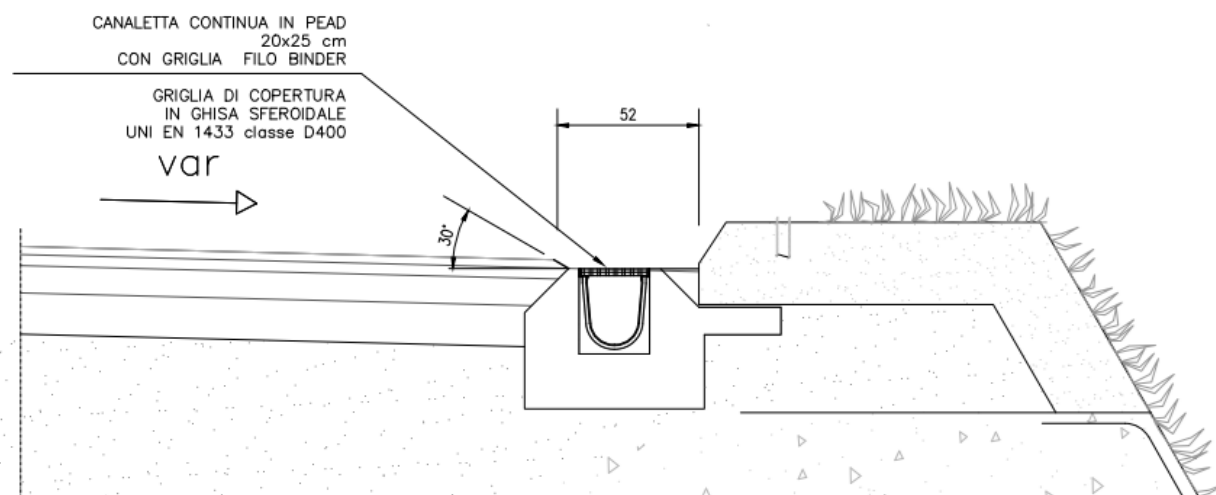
sezione tipo elemento di drenaggio in rilevato lungo le terre rinforzate.
